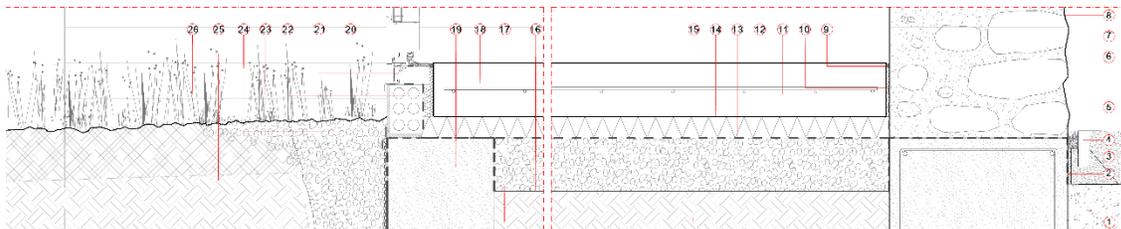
Detalle constructivo Casa 1413, HARquitectes.
